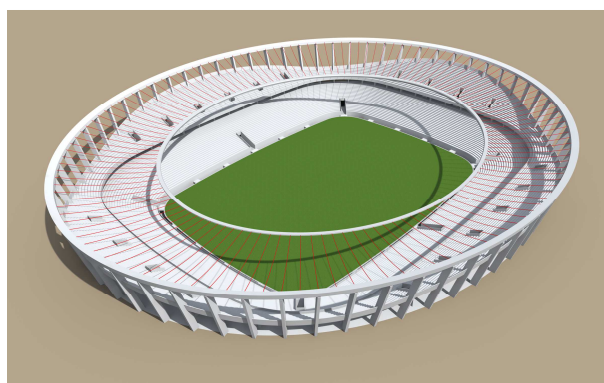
Tvar prefabrikovaného panelu (eliptická varianta zastřešení)
